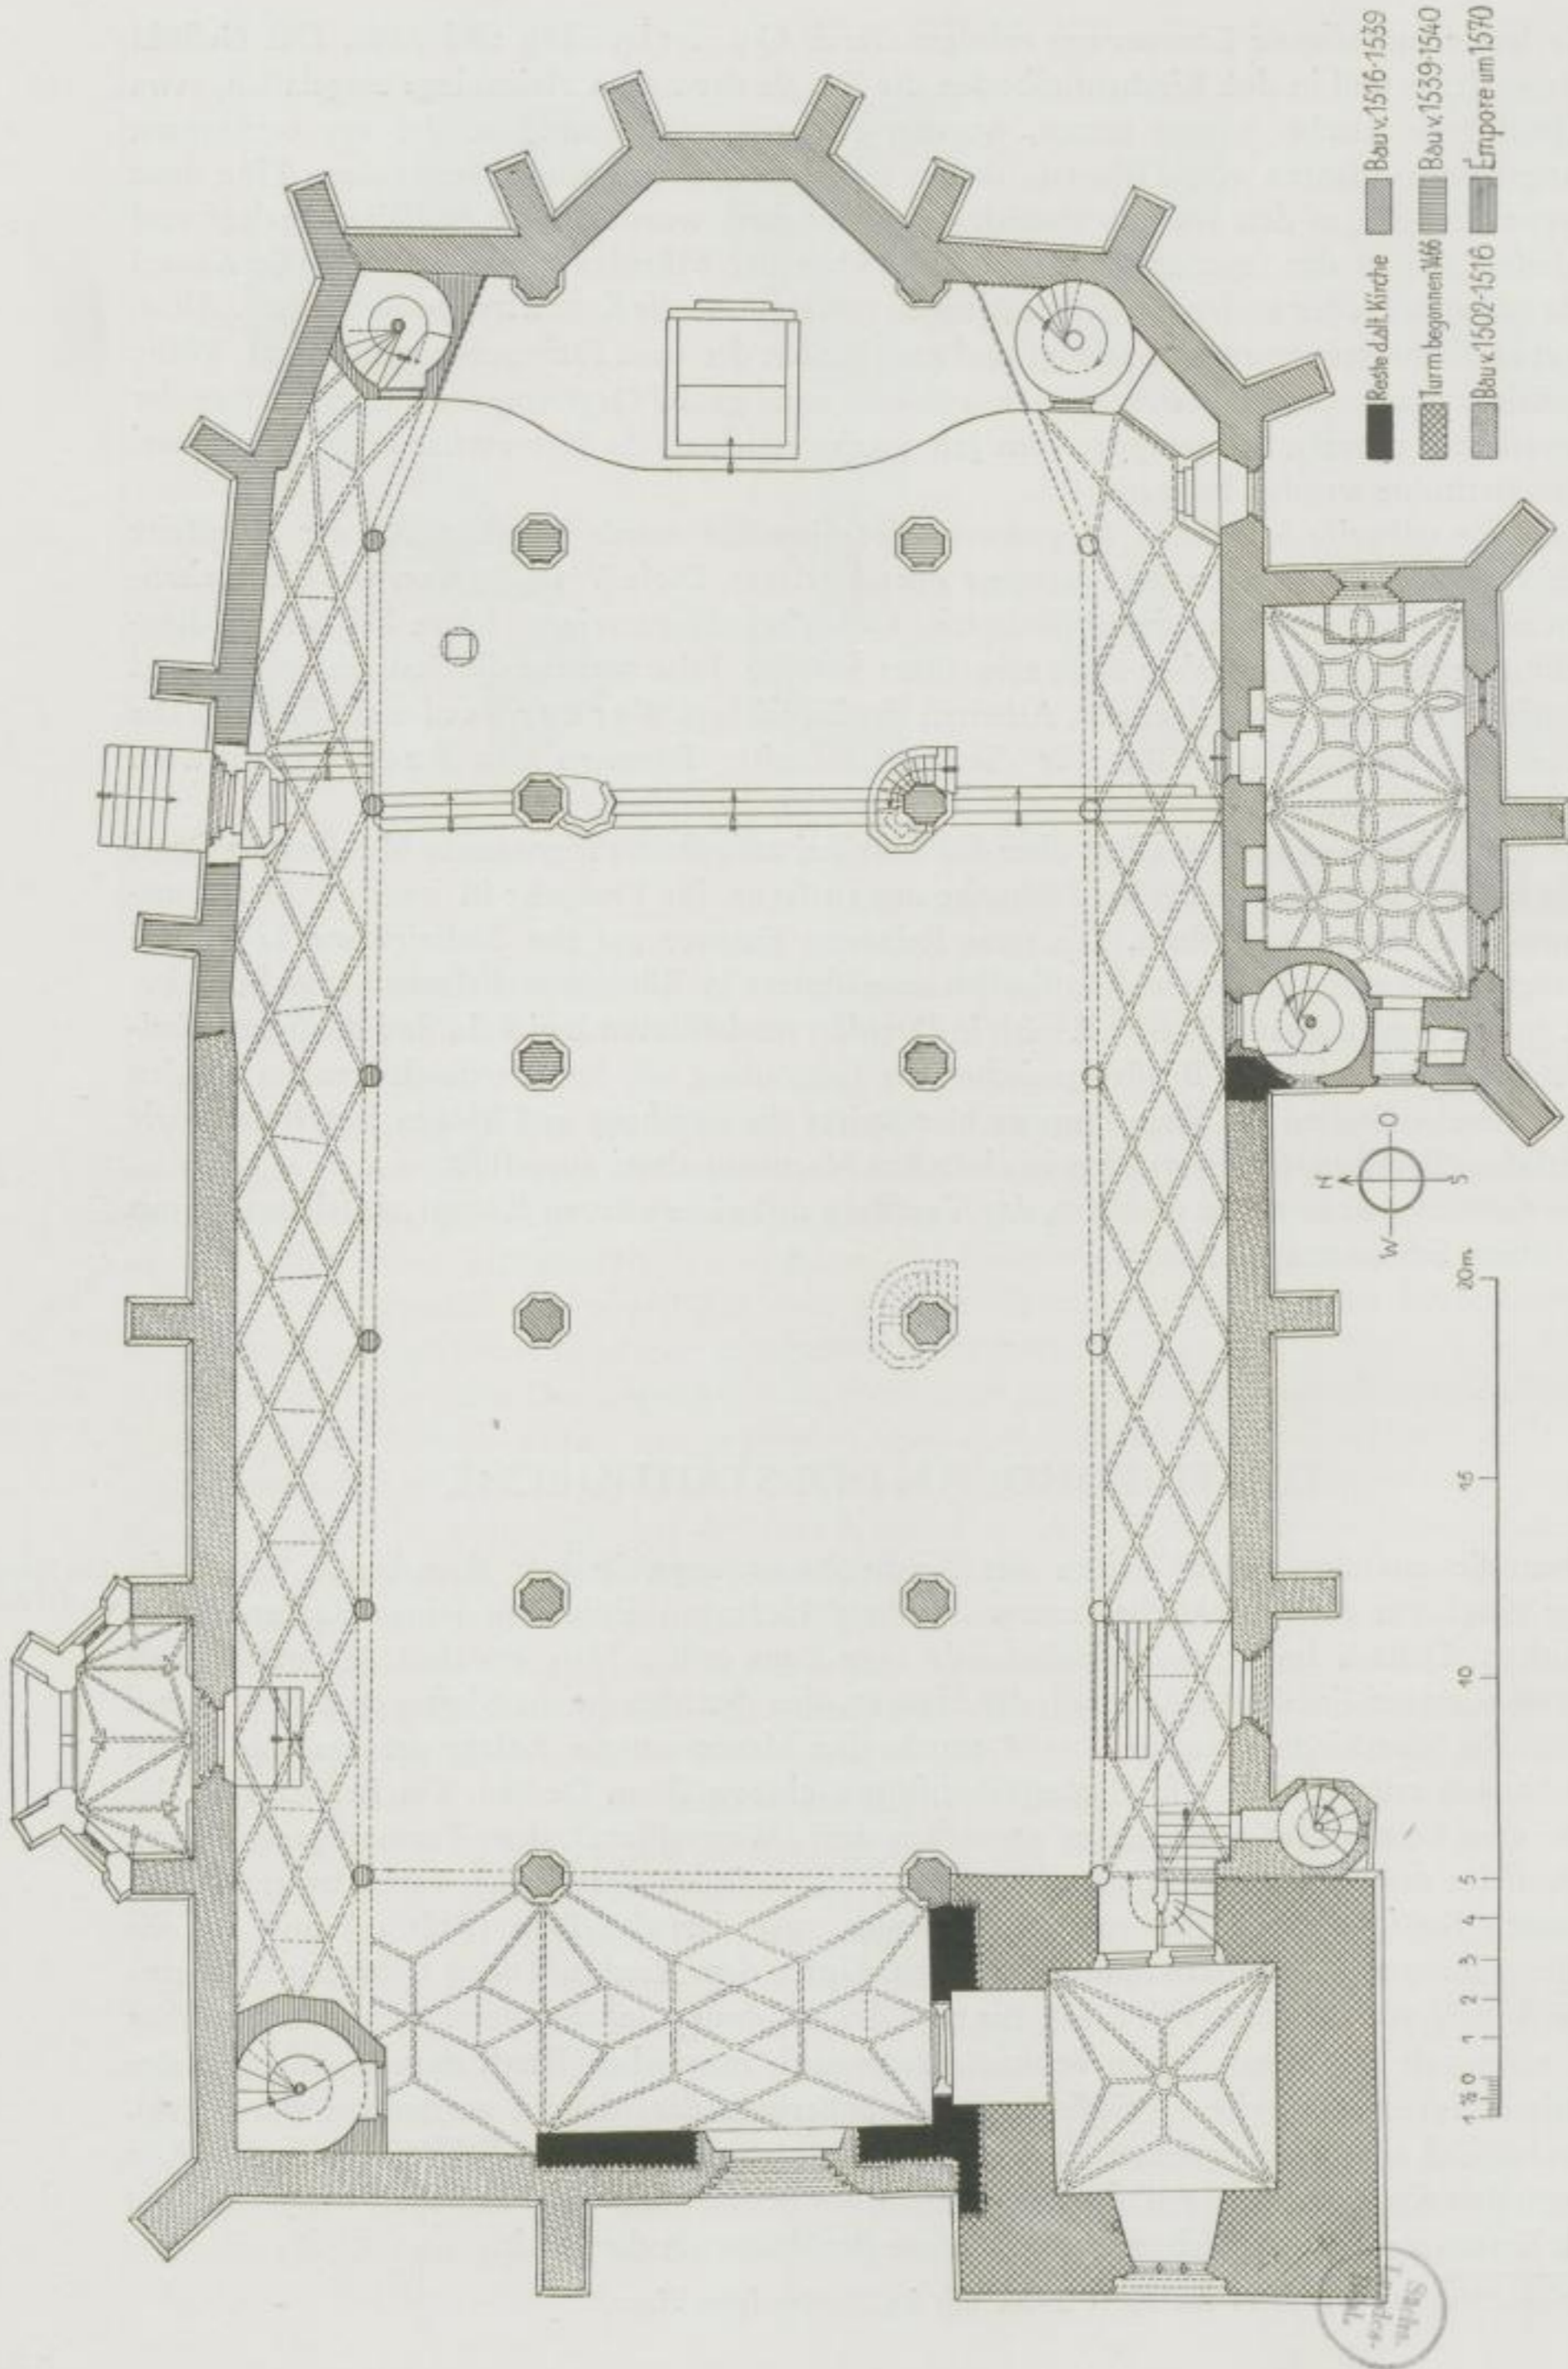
Grundriß der Stadtkirche in Turmhöhe (Aufn. Krebs)
